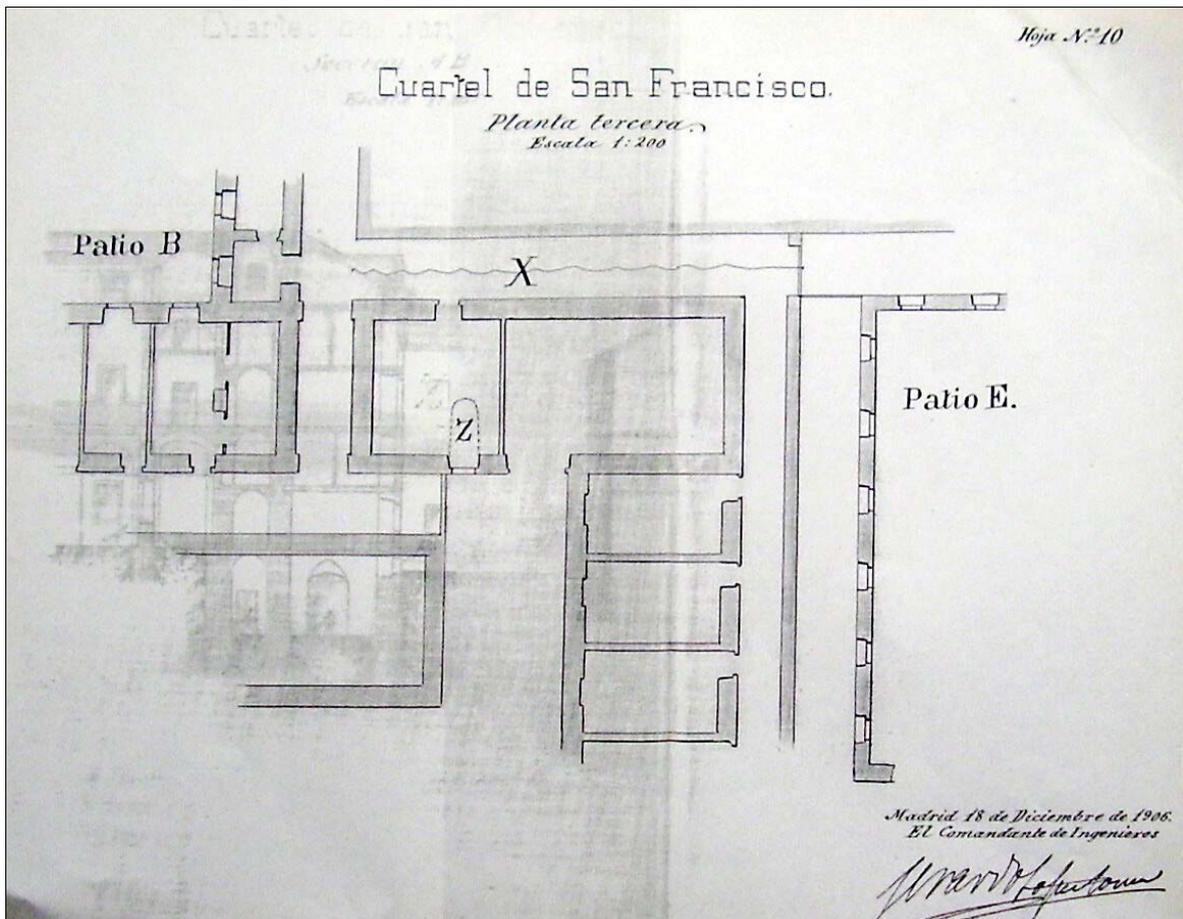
Cuartel de San Francisco. Levantamiento planimétrico de planta tercera de la zona de Prisiones Militares.* Escala original, 1:200. Archivo General Militar, Sección 3^a., división 3^a., leg. 580.
